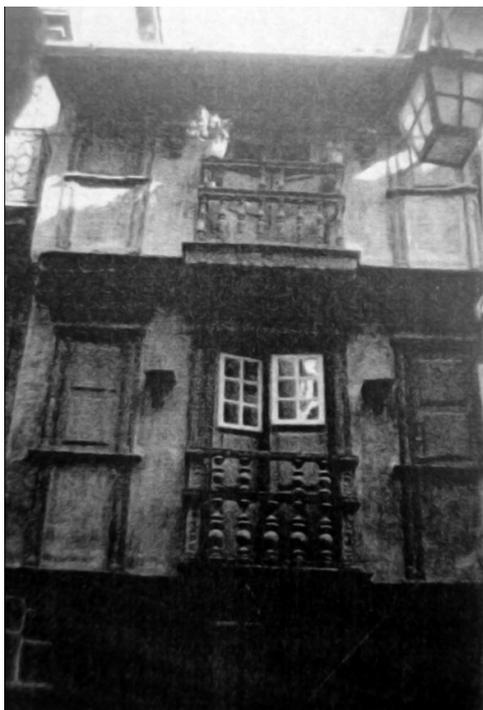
Pormenor da Fachada principal antes da intervenção, 1985
